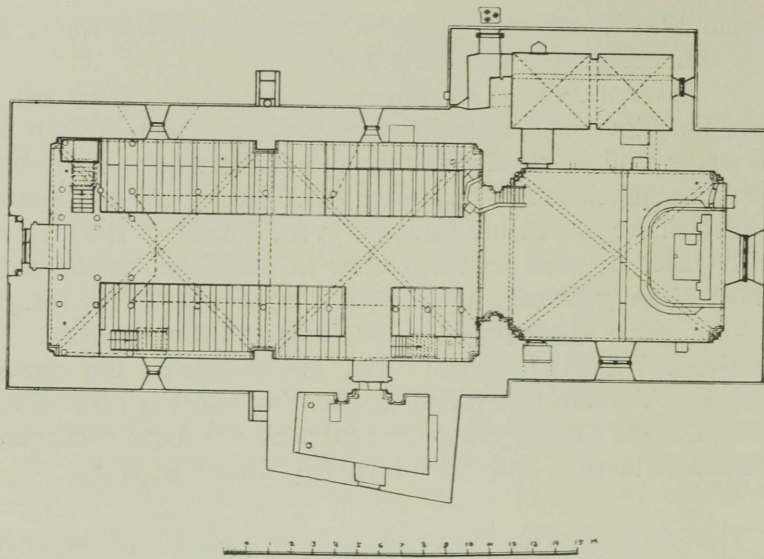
Grundriss der Kirche zu Karja. Aufmessung von Paulsen.
